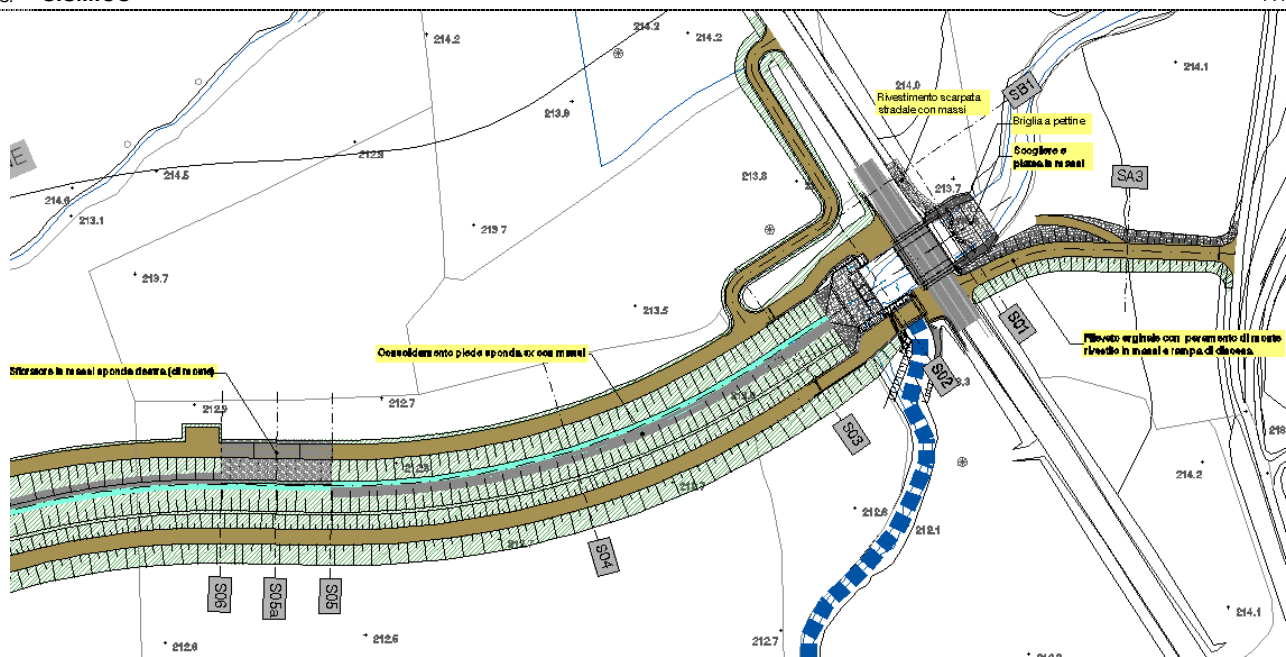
stralci della planimetria di progetto (tratto di valle e tratto di monte). Non in scala.
